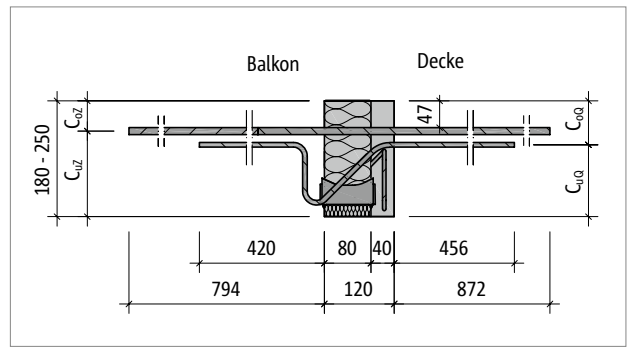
Schöck Isokorb® RT Typ K-M2: Produktschnitt
